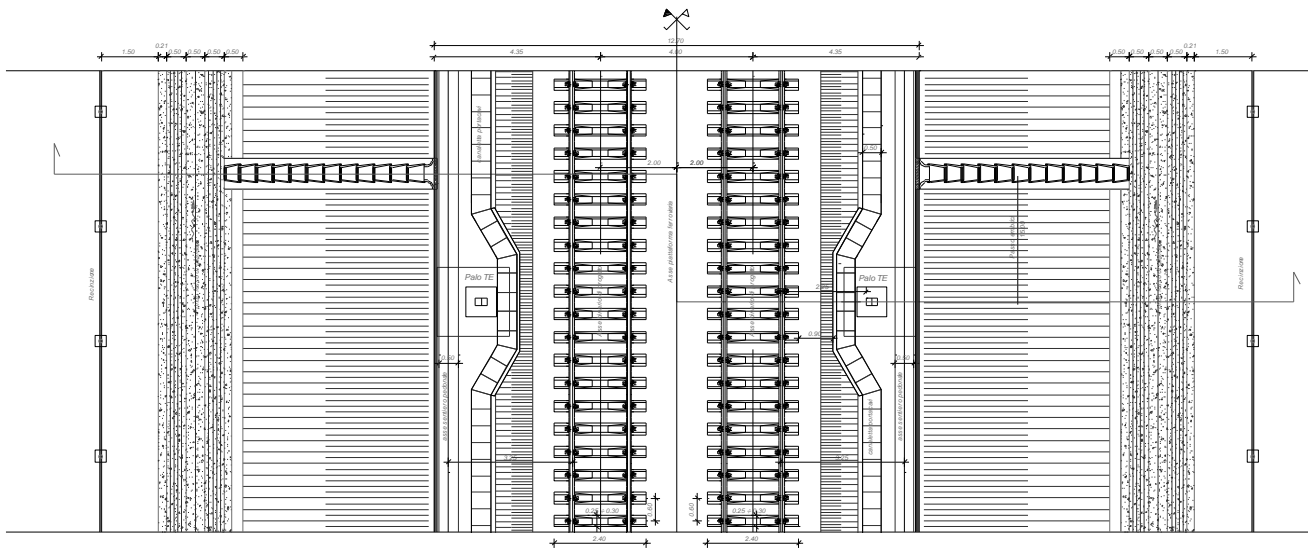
Stralcio planimetrico per sezione tipo ferroviaria in rilevato a doppio binario (piattaforma in retto) con $H_{ril} \leq 6,00$ m
